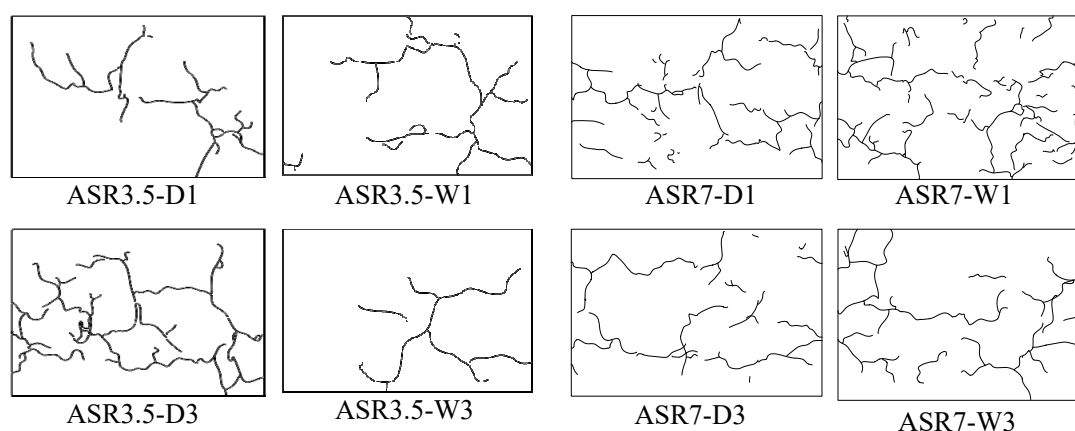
ひび割れ図 (円柱供試体側面展開)
